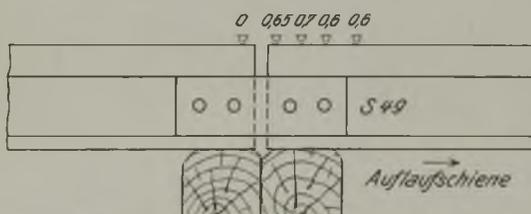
Ruhender Stoß auf Kuppelschwelle.
